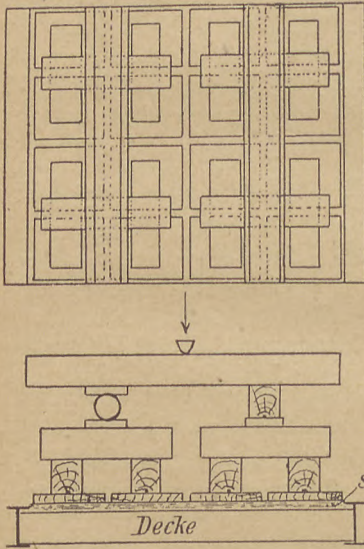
Belastungsaufbau bei Deckenprüfungen.
